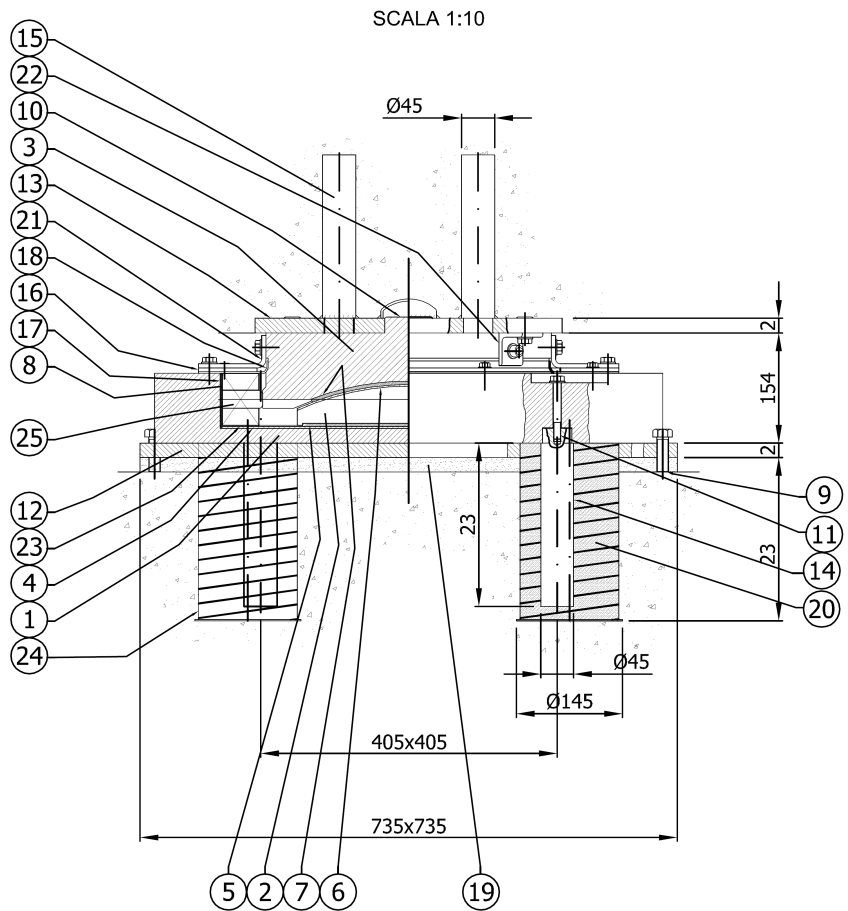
Particolare dell'appoggio fisso cedevole
